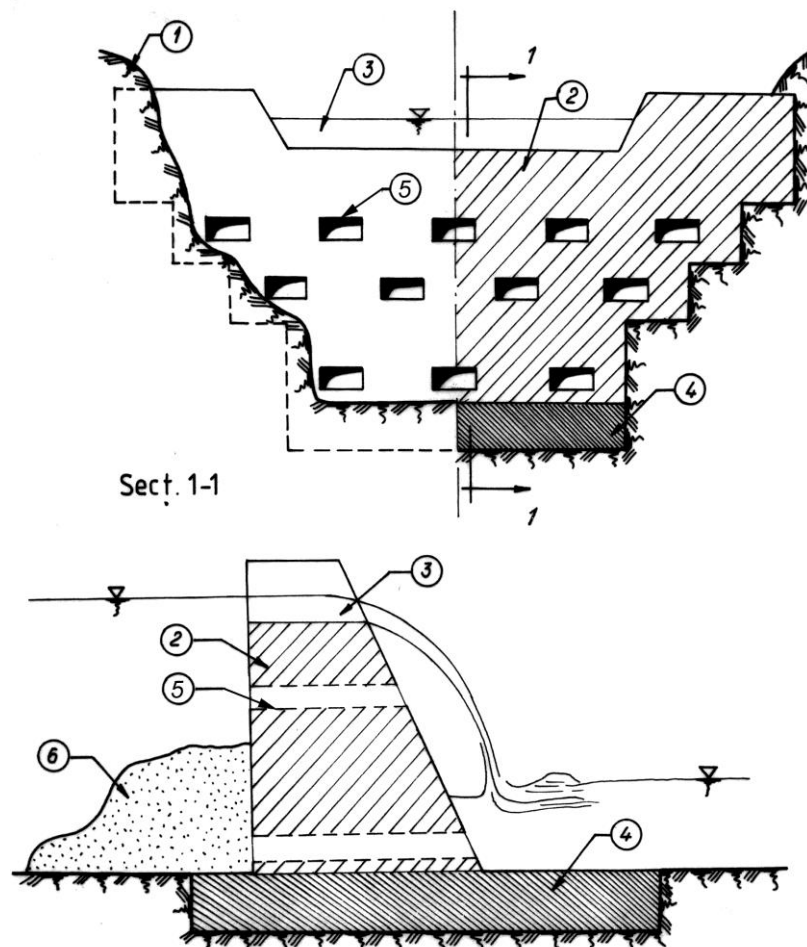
Baraj de beton pentru reținerea aluviunilor
